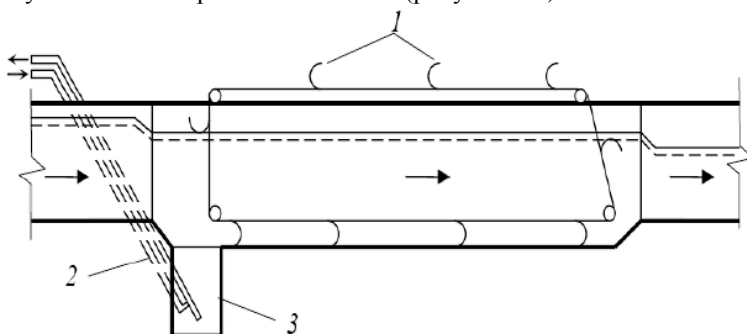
Схема горизонтальной песколовки (продольный разрез):
